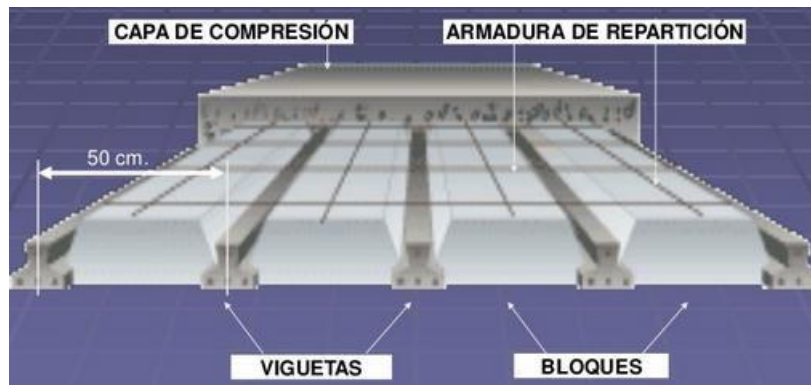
Detalle de losa alivianada con aligeramientos de poliestireno. (elaboración propia)
